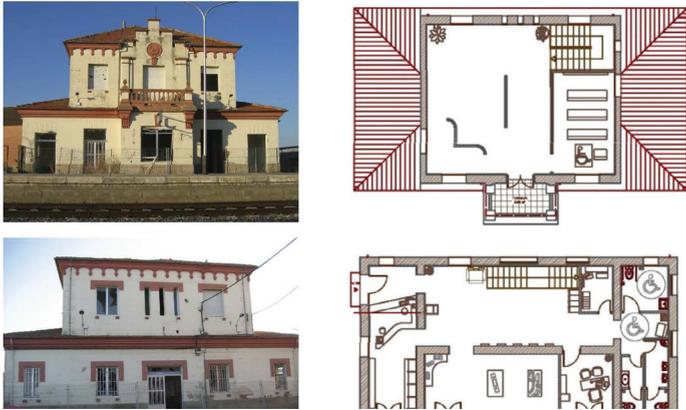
Apeadero de Crespos (Ávila). Iz. fachadas; Dch. plantas del proyecto de adaptación.
